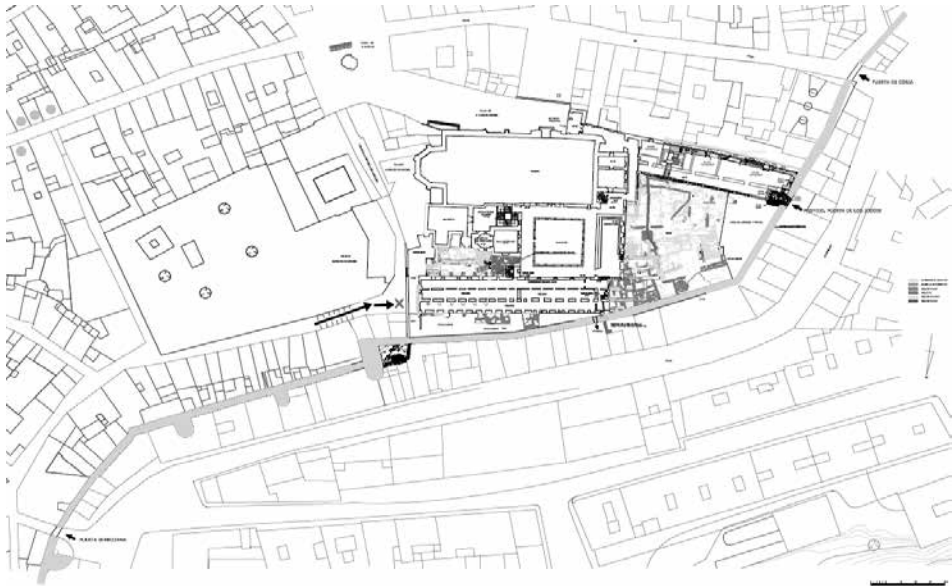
Plano con la estructura general del convento en la 2ª F. C. y todos los añadidos posteriores.
